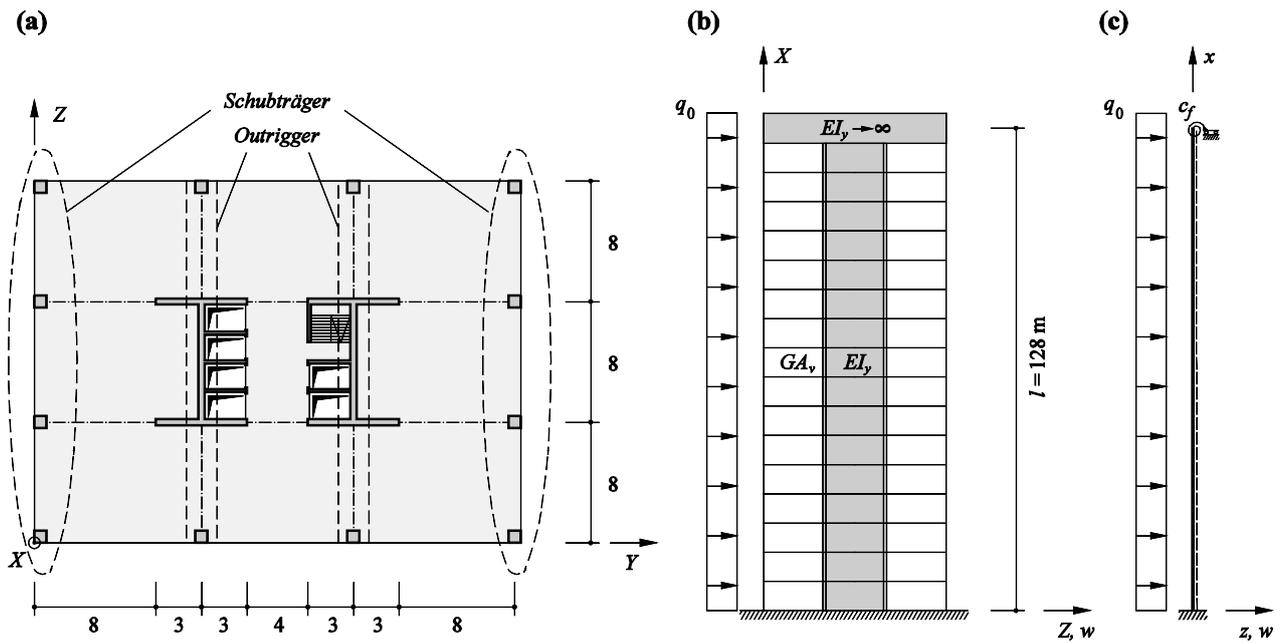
(a) Regelgrundriss (Abmessungen in m); (b) Schnitt und Belastung und (c) Idealisiertes System.
